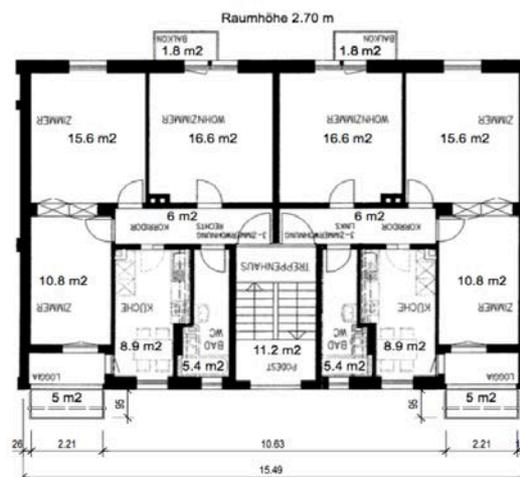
Grundriss OG, Rotachstrasse 50, 3-Zimmer-Wohnungen
